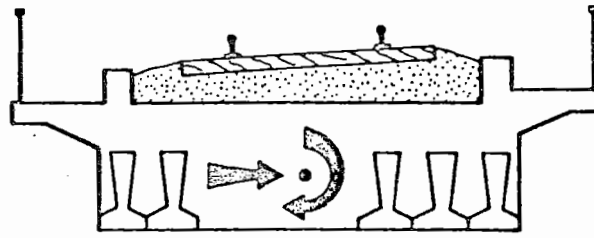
EFEITO DE AÇÃO DO VENTO NA SUPERESTRUTURA EM PONTE DE LAJE
